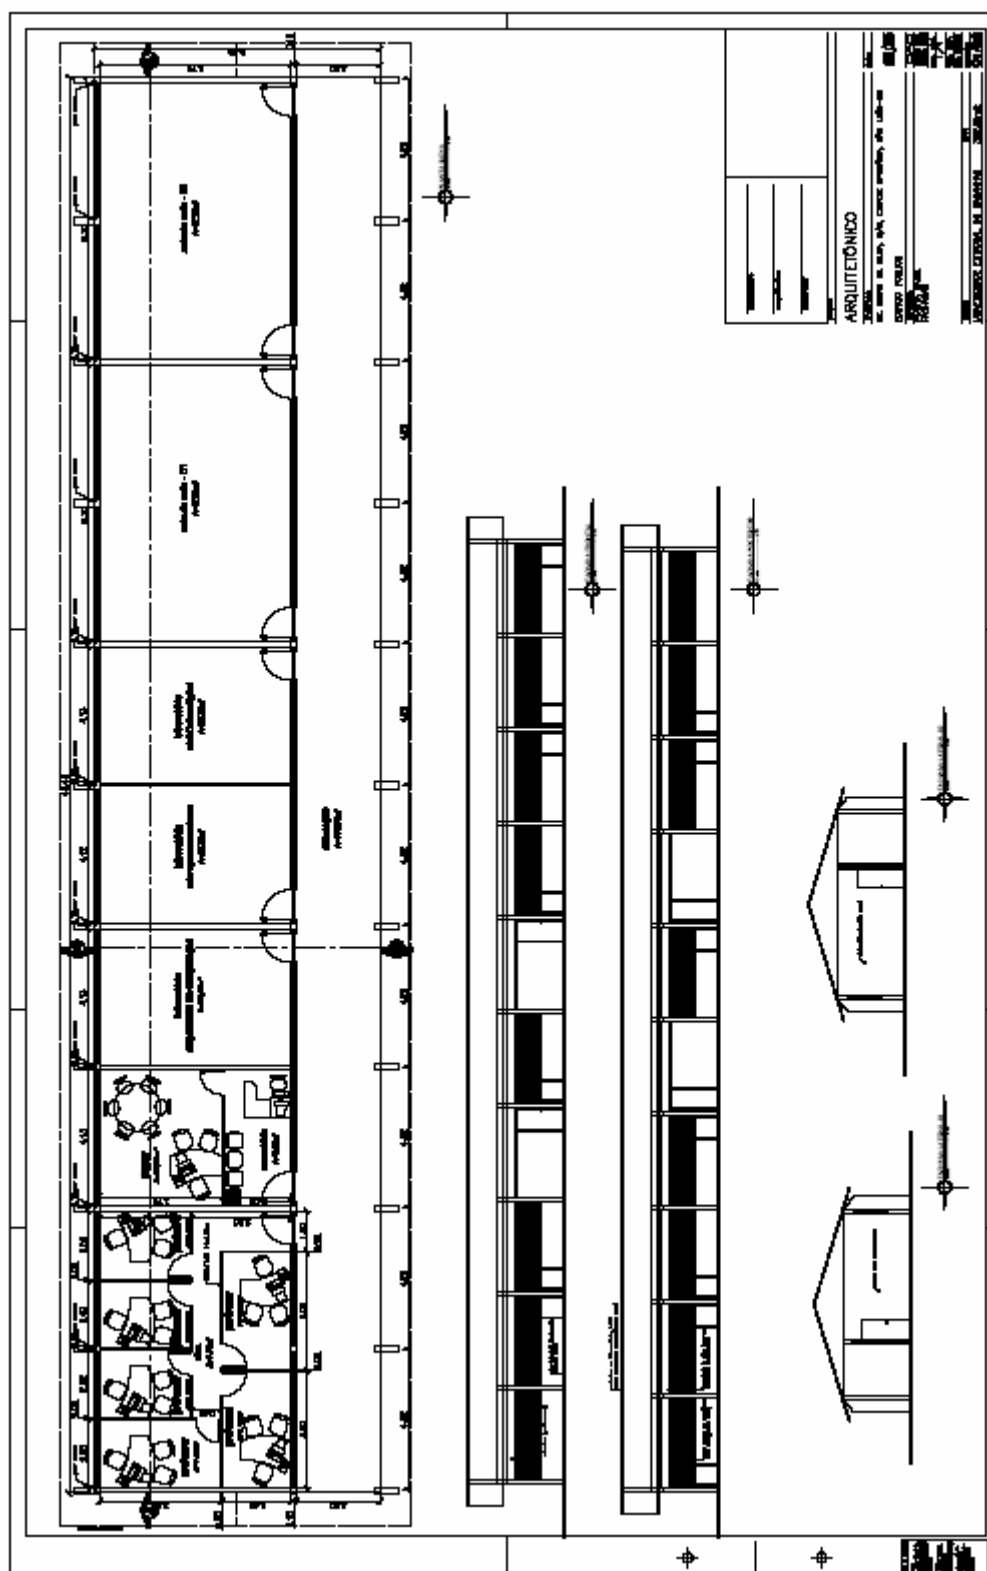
Planta baixa e fachada do prédio de Engenharia de Computação
